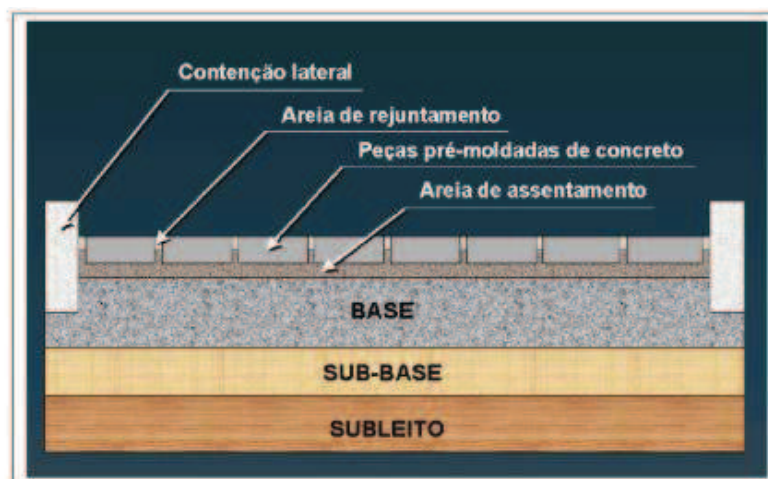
Estrutura do pavimento de PPC (HALLACK, 1998)
